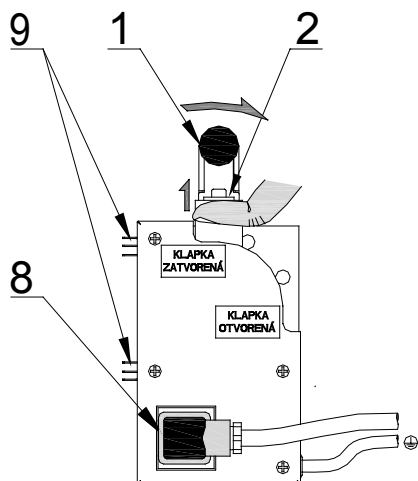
Ручной включающий механизм для малых пожарных клапанов
